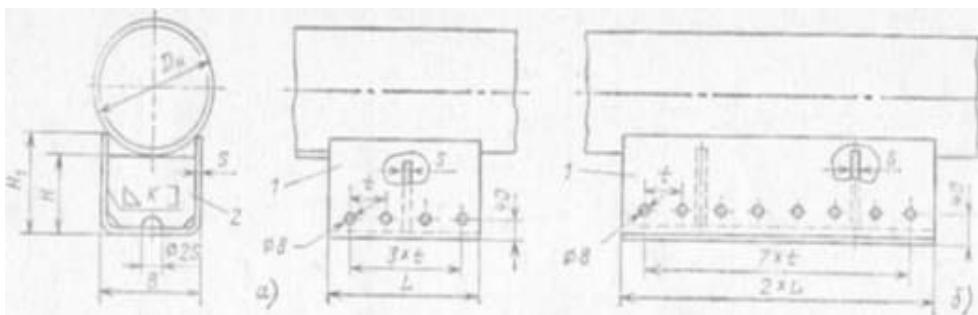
Скользящая опора (подвижная) для труб Ду=100,1400 мм: корпуса для опор типа ОПП-2 (а). ОПП-3 (б); 1 - корпус; 2 - ребро
